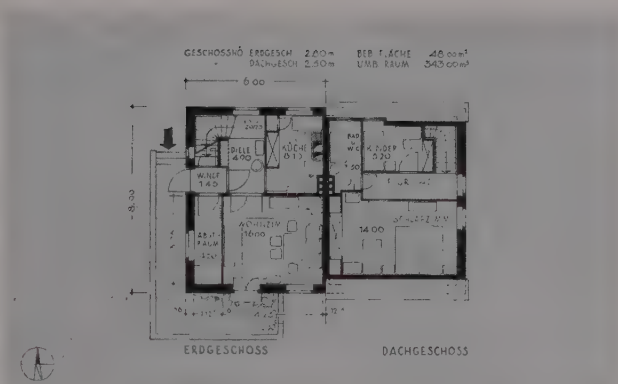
2 1/2-Zimmer-Doppelwohnhaus für den Eigenheimbau auf dem Lande, Vorschlag für Mitteldeutschland, Grundriß Erdgeschoß und Dachgeschoß
